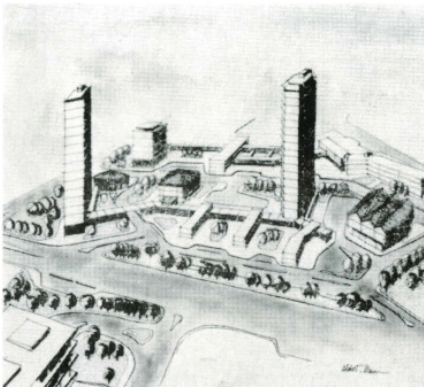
Prospettiva a volo d'uccello del Centro direzionale, dal progetto del piano degli ingegneri, disegno dell'architetto Aldo Villani.
